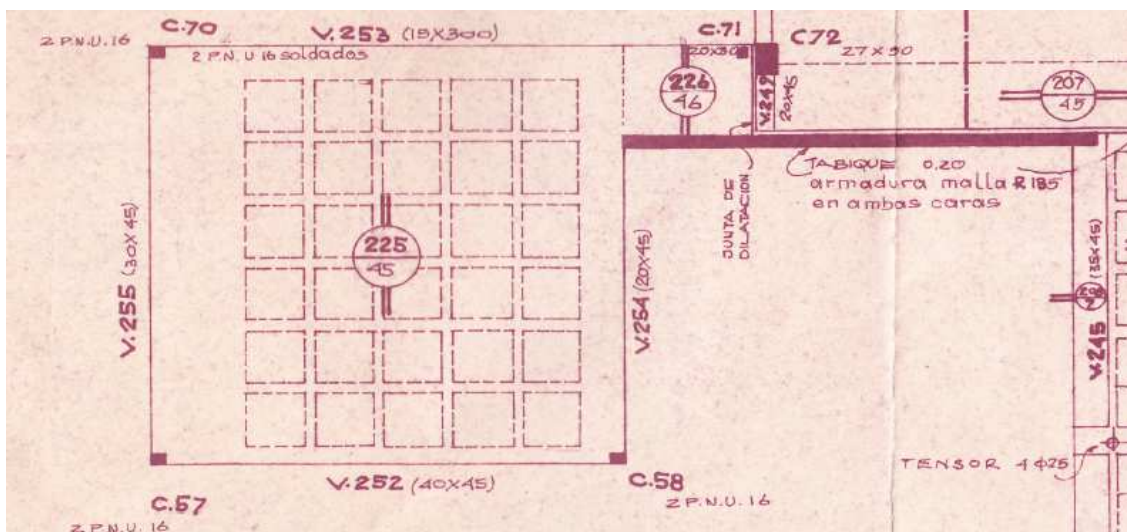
Plano de estructuras – Fuente: Digitalización de planos originales
